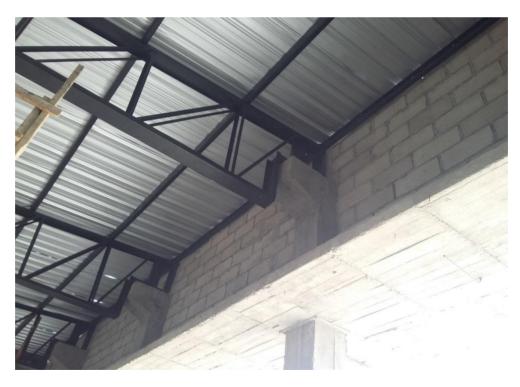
VISTA LATERAL DE LA CERCHA TIPO HOWE, APOYADA SOBRE LA BASE.
